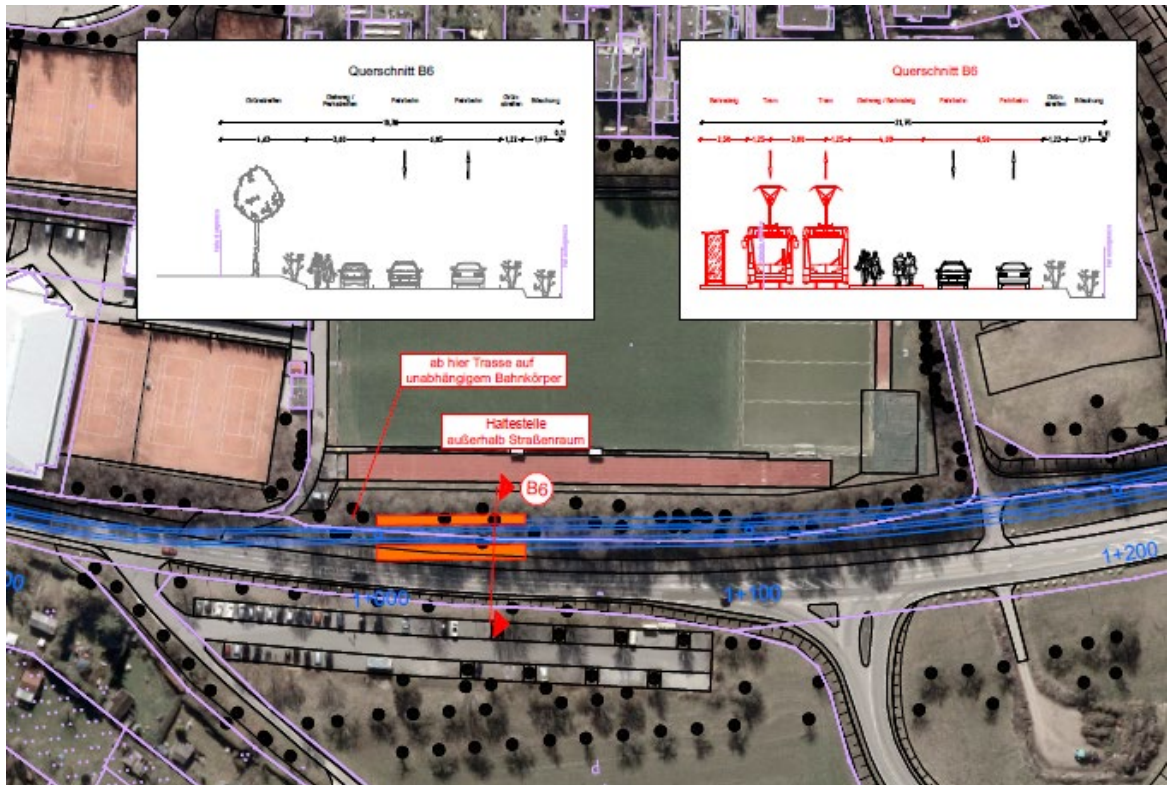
Variante B, Führung in Seitenlage mit Haltestelle außerhalb der Straßenraumes
